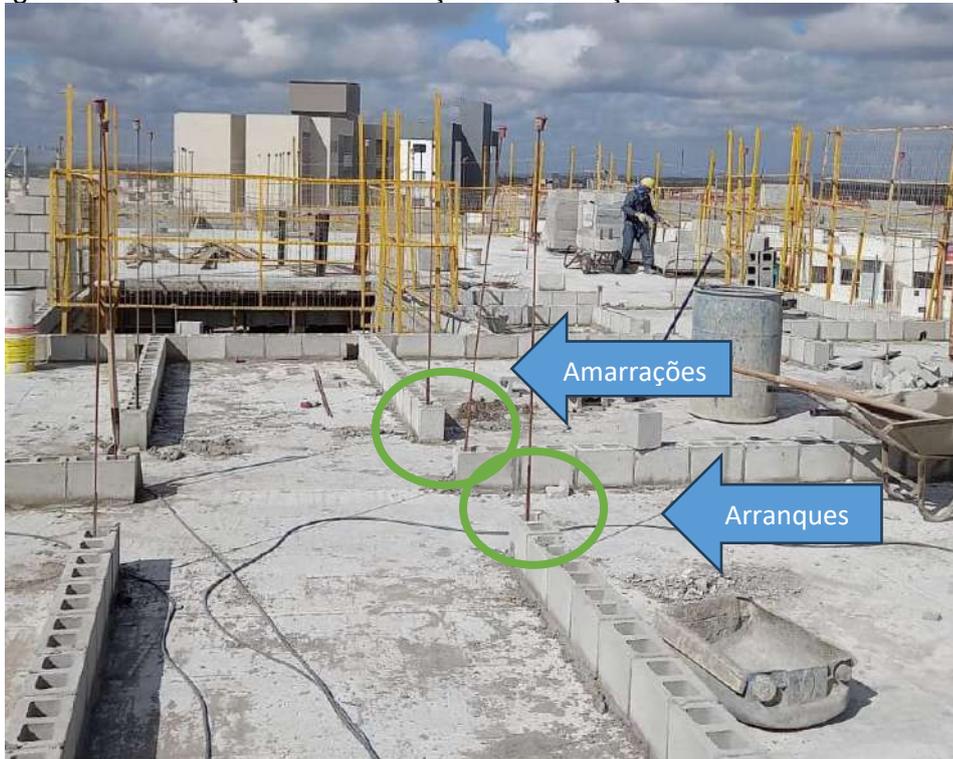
Detalhes genéricos do assentamento de blocos em planta
